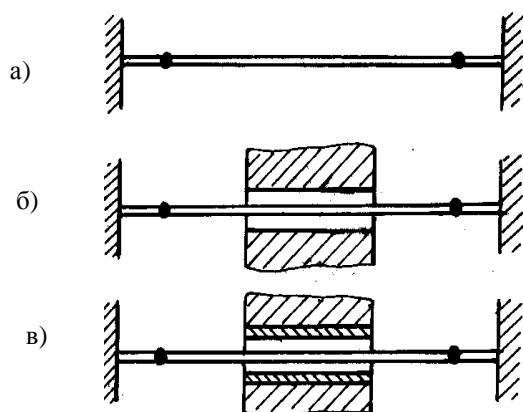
Варіанти схем напруження арматури: а – нагрівання відкритої арматури; б – нагрівання арматури в каналі; в – нагрівання арматури в каналі з металевим каналотворювачем
